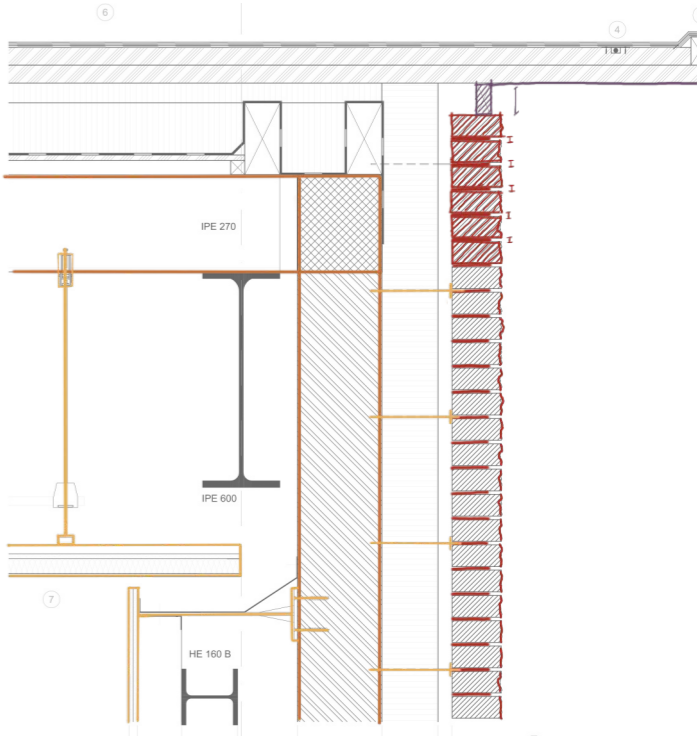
Detalle constructivo en sección de la composición de la envolvente. Encuentro con la cubierta.
